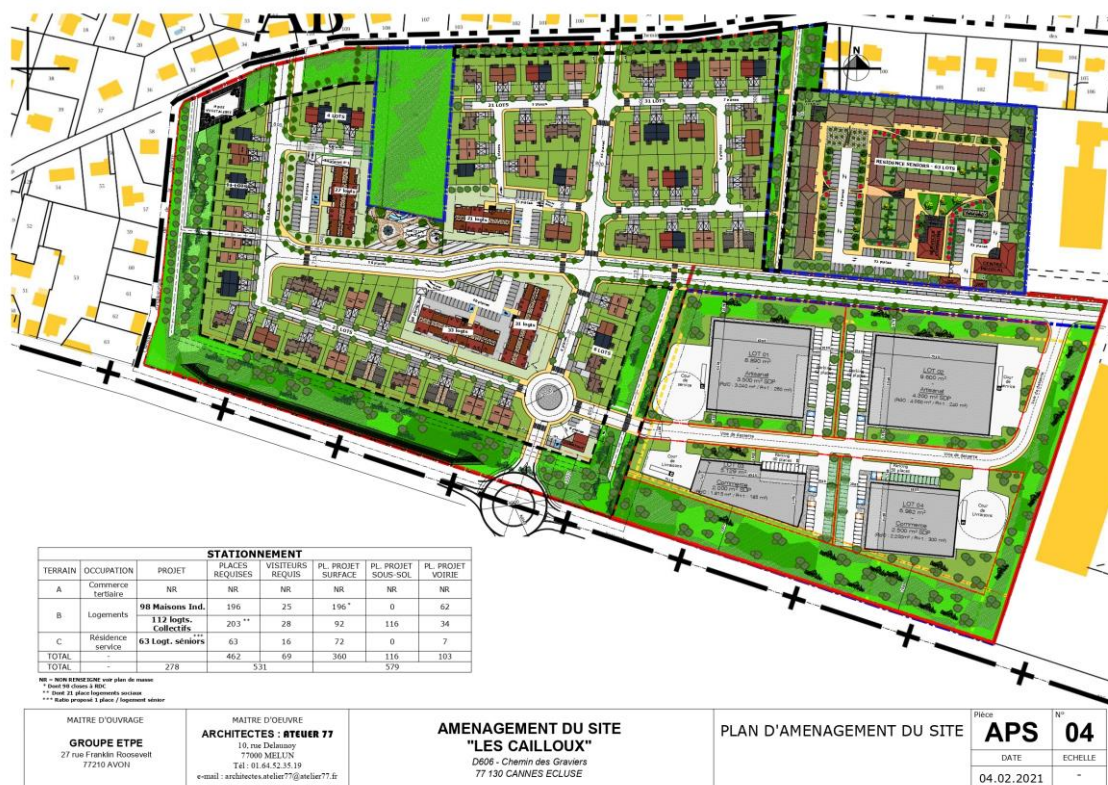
Plan d'aménagement de la zone « Les Cailloux »
